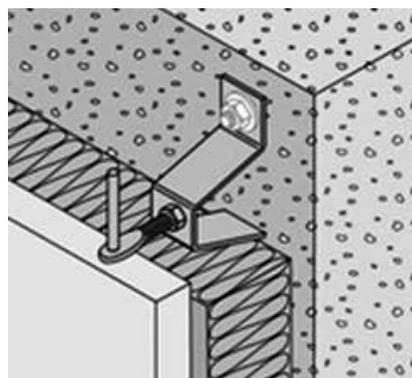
Corte esquemático com esquema de fixação de placas de rocha em fundo de viga. (ENOX, 2014)
